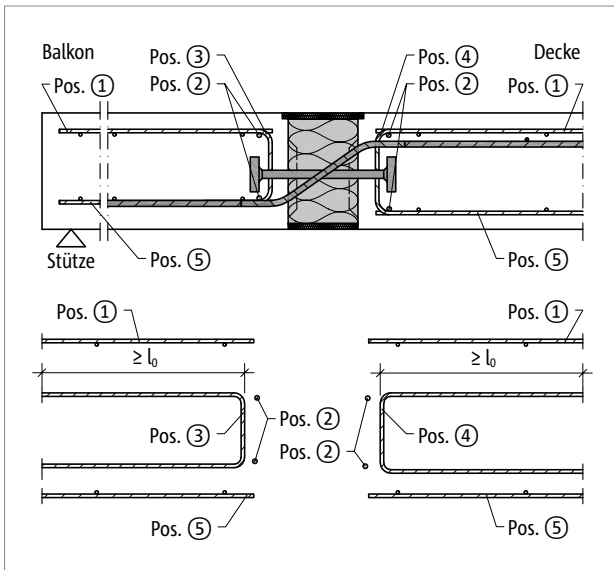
Schöck Isokorb® XT Typ QP: Bauseitige Bewehrung
